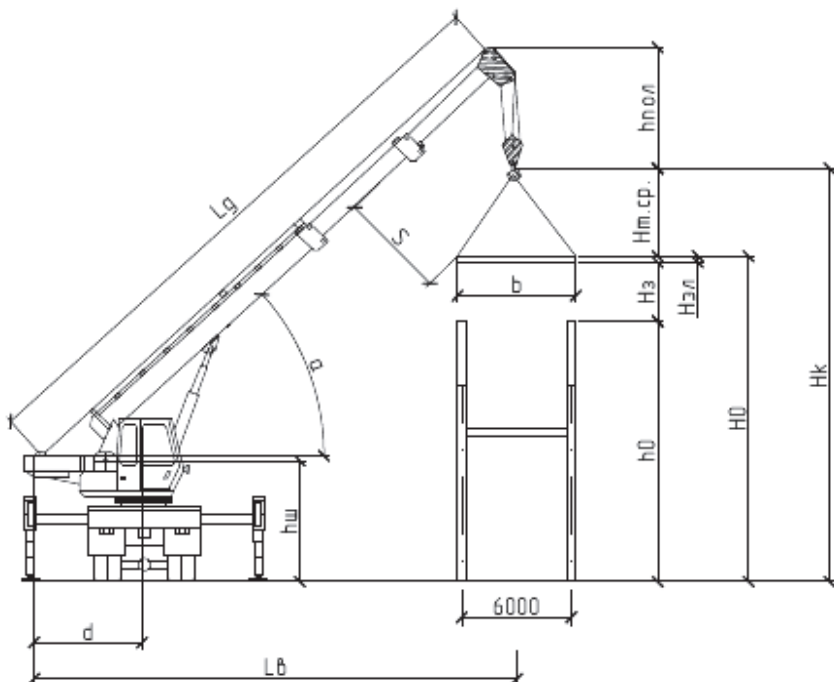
Расчетная схема при монтаже плит покрытия с применением крана с выдвижной стрелой: H_3 – запас по высоте, требующийся по условиям безопасности монтажа, т.е. для безопасной заводки конструкции к месту установки или переноса через ранее смонтированные конструкции, $H_3 = 0,5$ м; S – расстояние от края монтируемого элемента до оси стрелы, $S = 1,5$ м; d – расстояние от оси вращения платформы крана до оси опоры стрелы, $d = 1,5$ м; $h_{ш}$ – превышение шарнира пяты стрелы над уровнем стоянки крана, $h_{ш} = 1,5$ м; $H_{эл}$ – высота (толщина) плиты покрытия или иного монтируемого элемента, $H_{эл} = 0,3$ м; $h_{пол}$ – высота полиспаста, $h_{пол} = 1 \dots 1,5$ м; h_0 – высота монтажного горизонта для плиты покрытия, принимается равной высоте здания до низа стропильной конструкции и максимальной высоты стропильной конструкции, м; $h_{т.ср}$ – высота такелажных средств (строп), м
